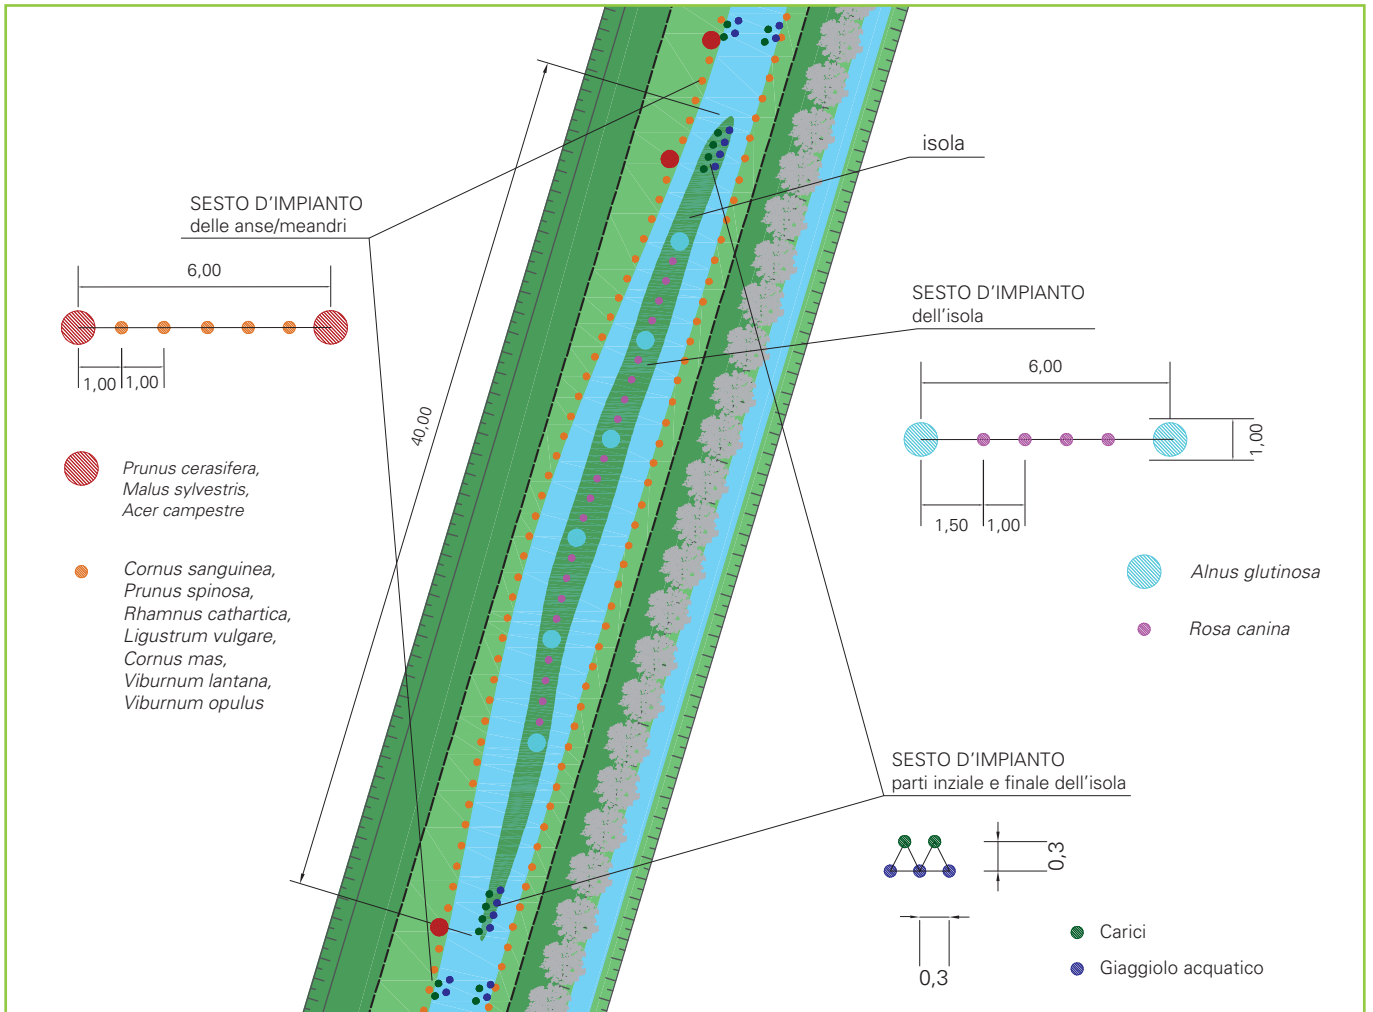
Planimetria dell'area di intervento di realizzazione del canale di infiltrazione
